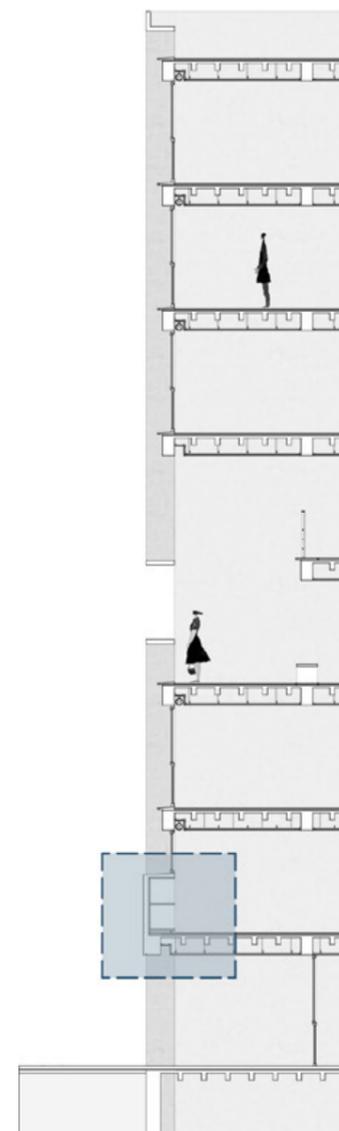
Ubicación del detalle constructivo 2. Fuente: Elaboración propia.
